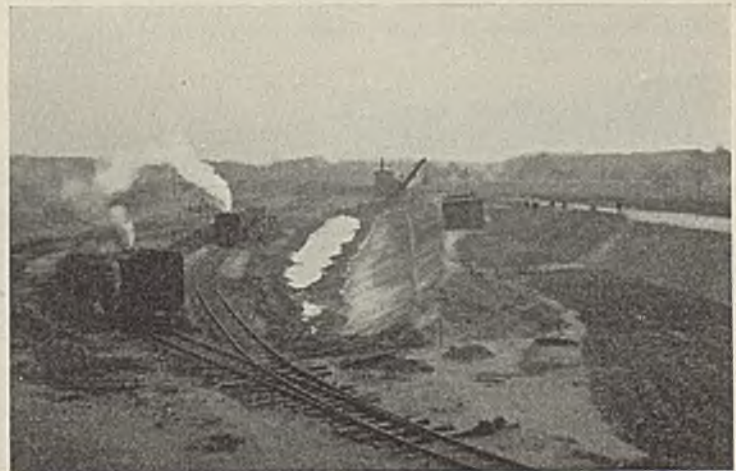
Blick von der Brücke ins nördliche Baufeld. Links: Handschacht; rechts: Entwässerungsschlitz und Inselkippe.
